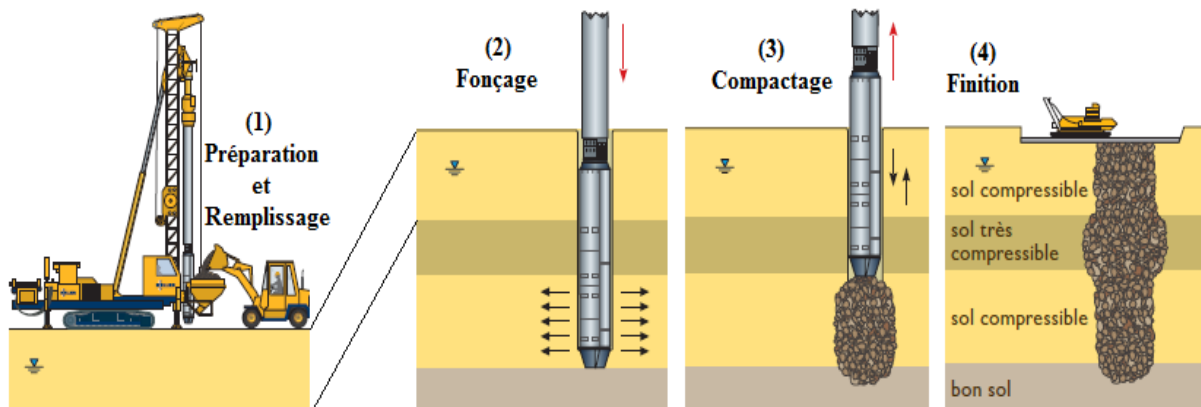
Principe de renforcement des sols par colonnes ballastées.
